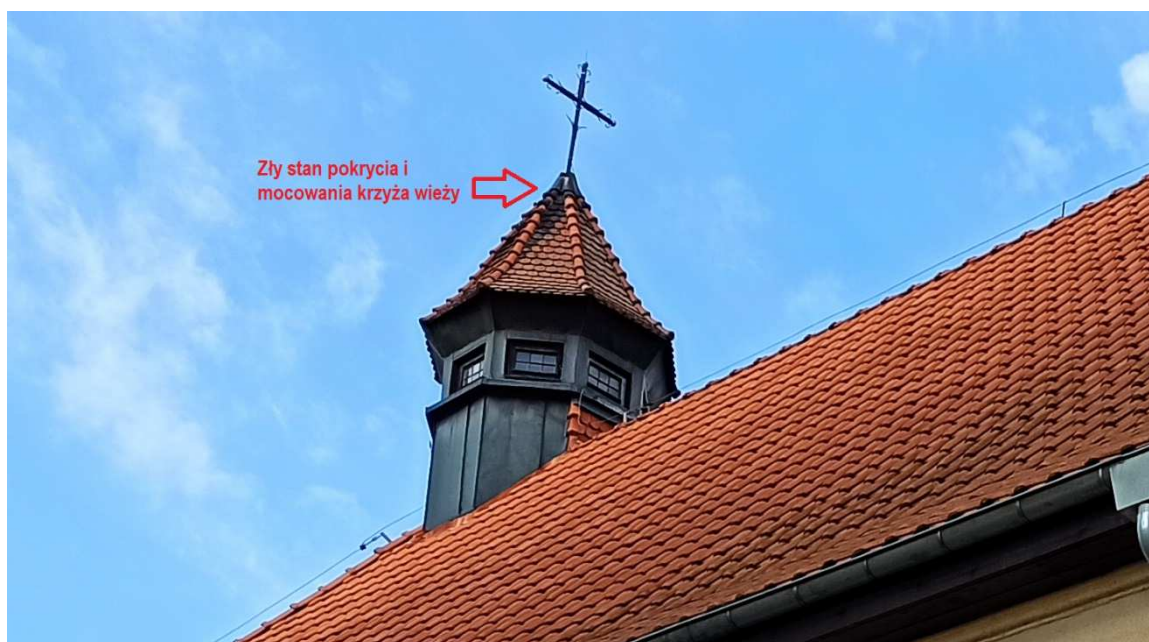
Elewacja zachodnia-boczna – podgląd stanu istniejącego z opisem elementów
